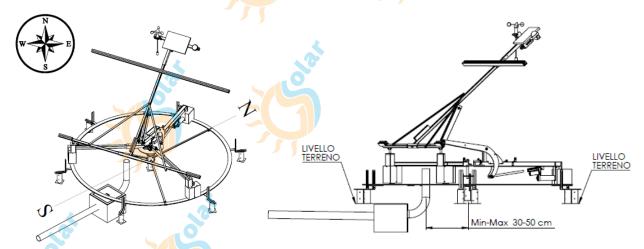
Vista posizione del pozzetto e tubi passacavi
